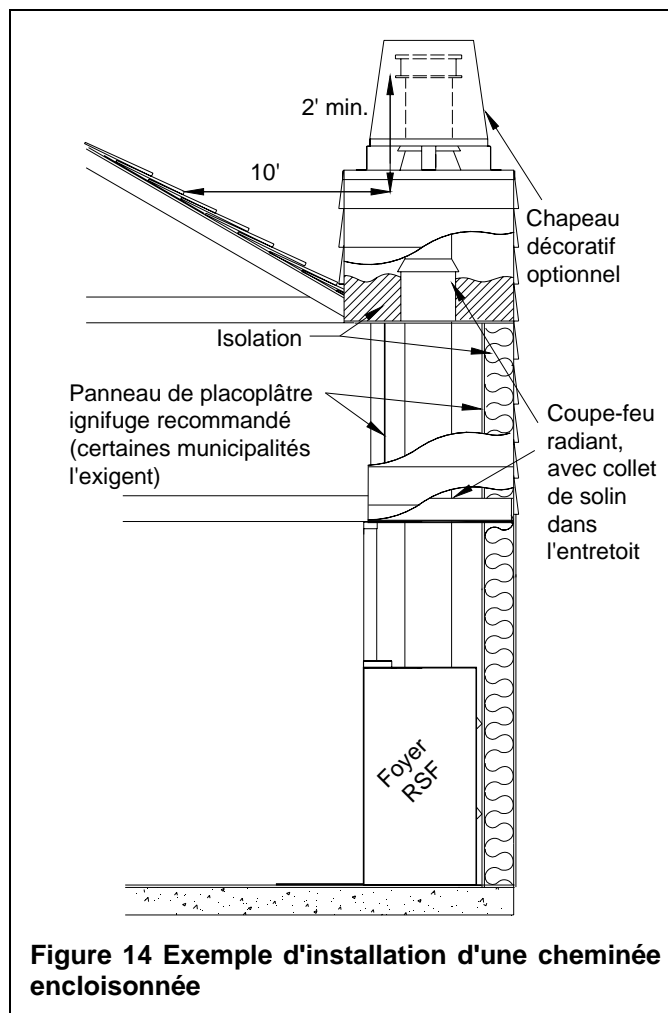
Exemple d'installation d'une cheminée encloisonnée
